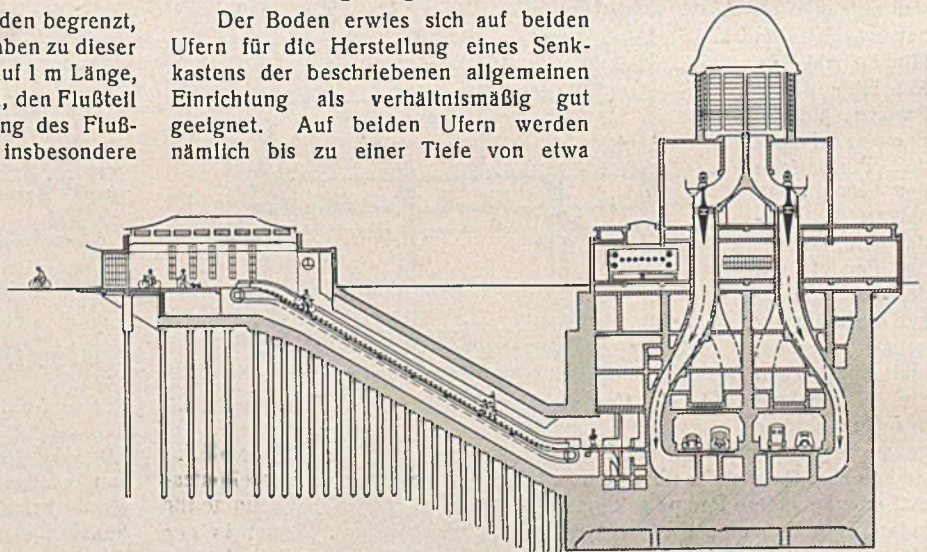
Schnitt durch Entlüftungsgebäude und Fahrtreppenschacht.
